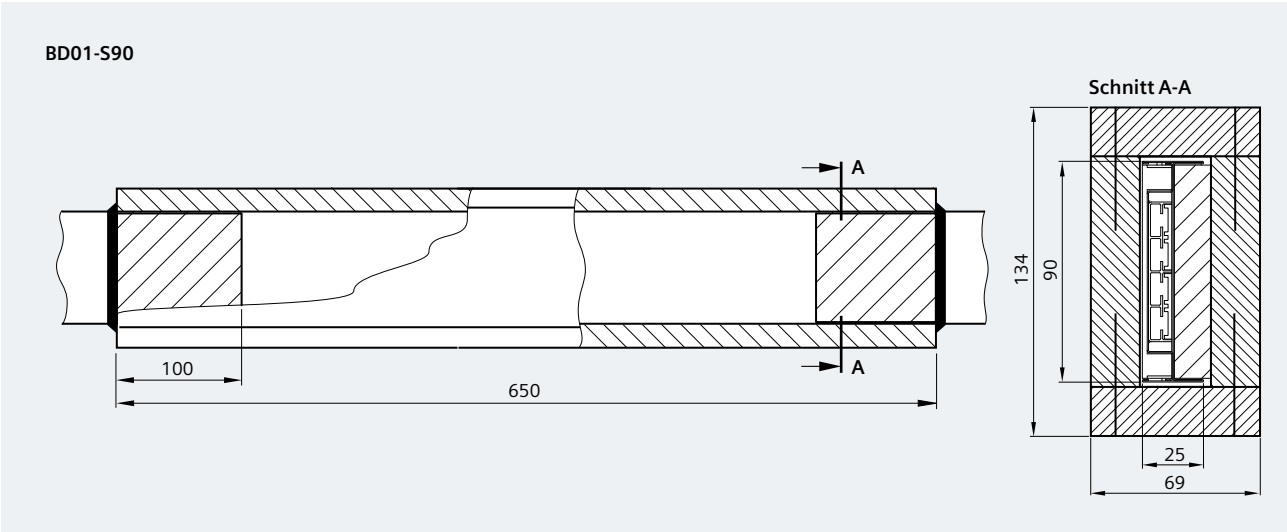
/16: Maßzeichnung für Brandschutzkit BD01-S90 (Maße in mm; Abmessungen der Durchbrüche für die Brandschottung siehe Abb. 3/4)
